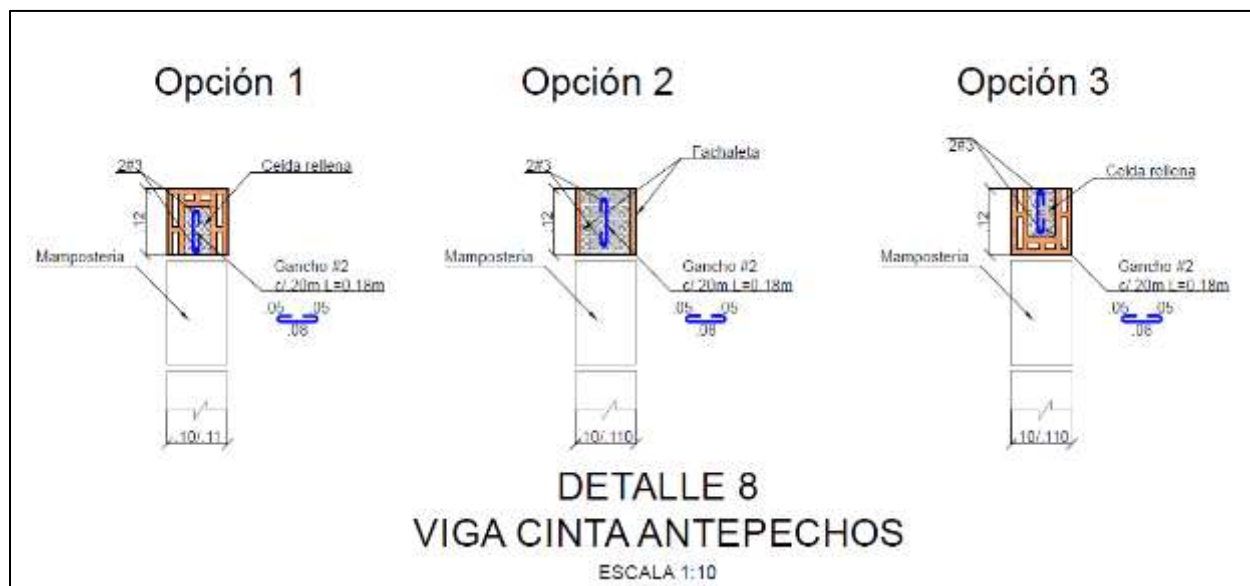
Detalle mampostería en fachada, refuerzo y detalle de dovela.
